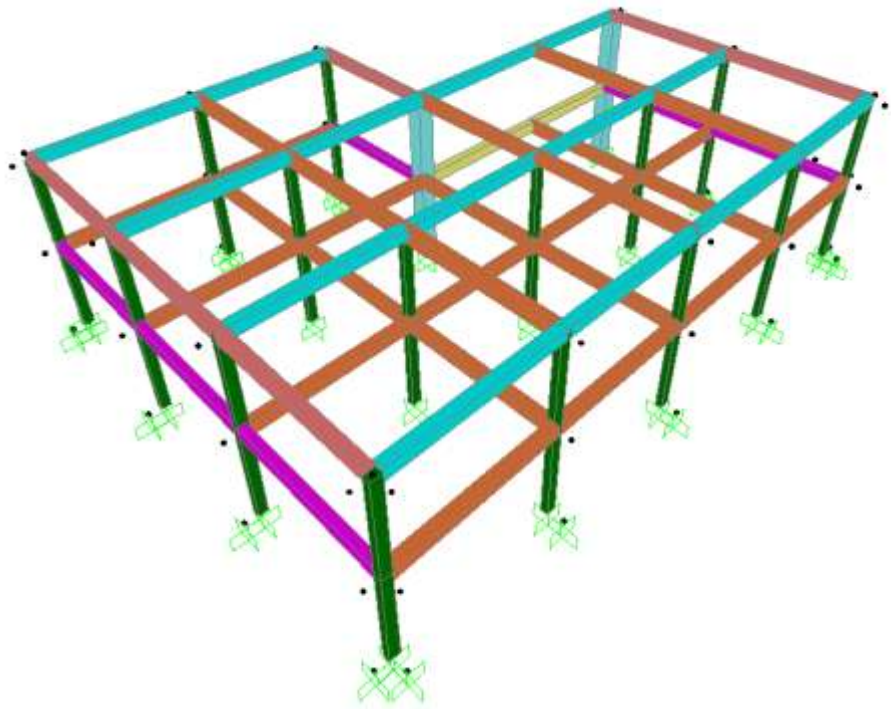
Propuesta de reforzamiento - edificio de gimba.
